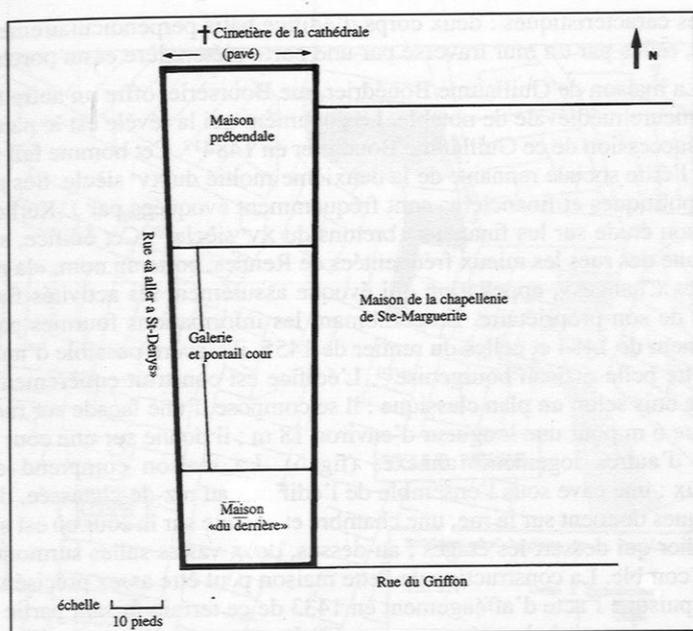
Plan restitué d'une maison prébendale en 1566
